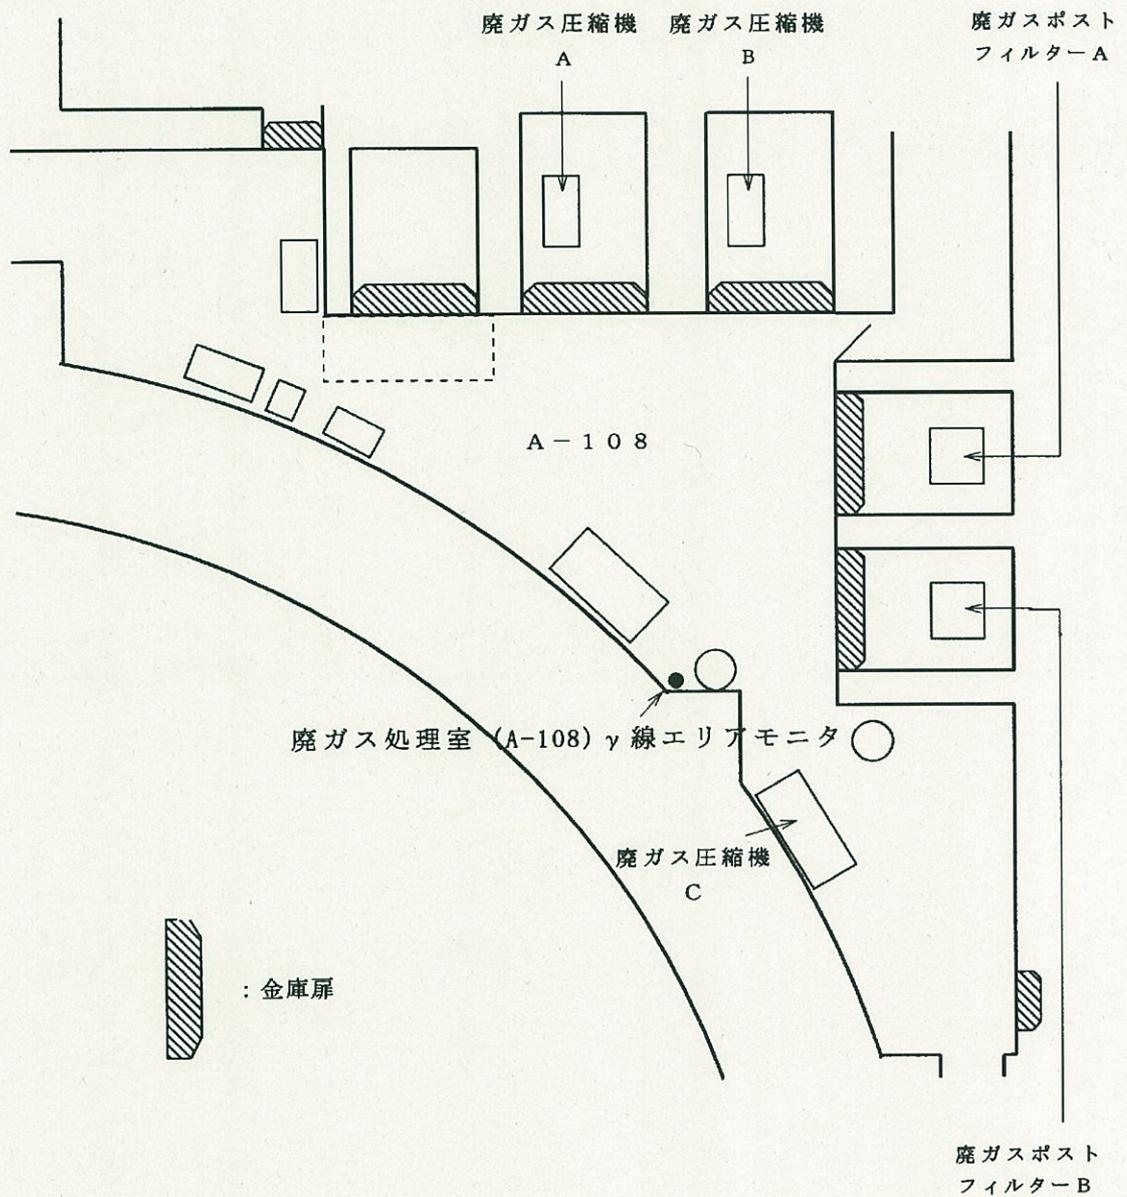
原子炉付属建家 A-108 γ 線エリアモニタ配置図
